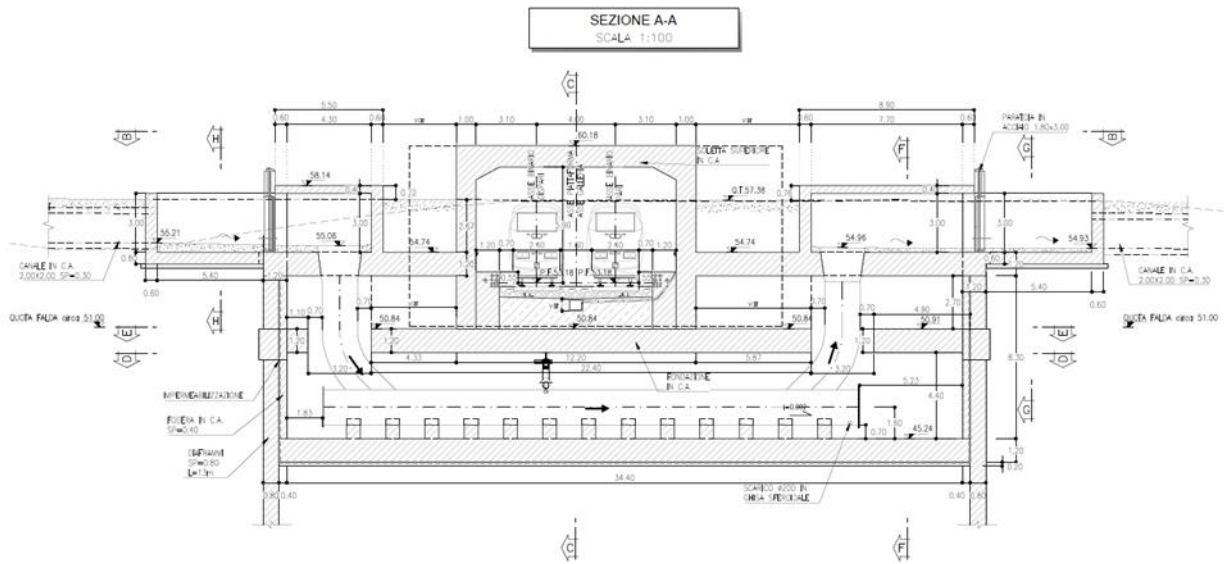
Sezione longitudinale IN02 – Sifone Via Cava
